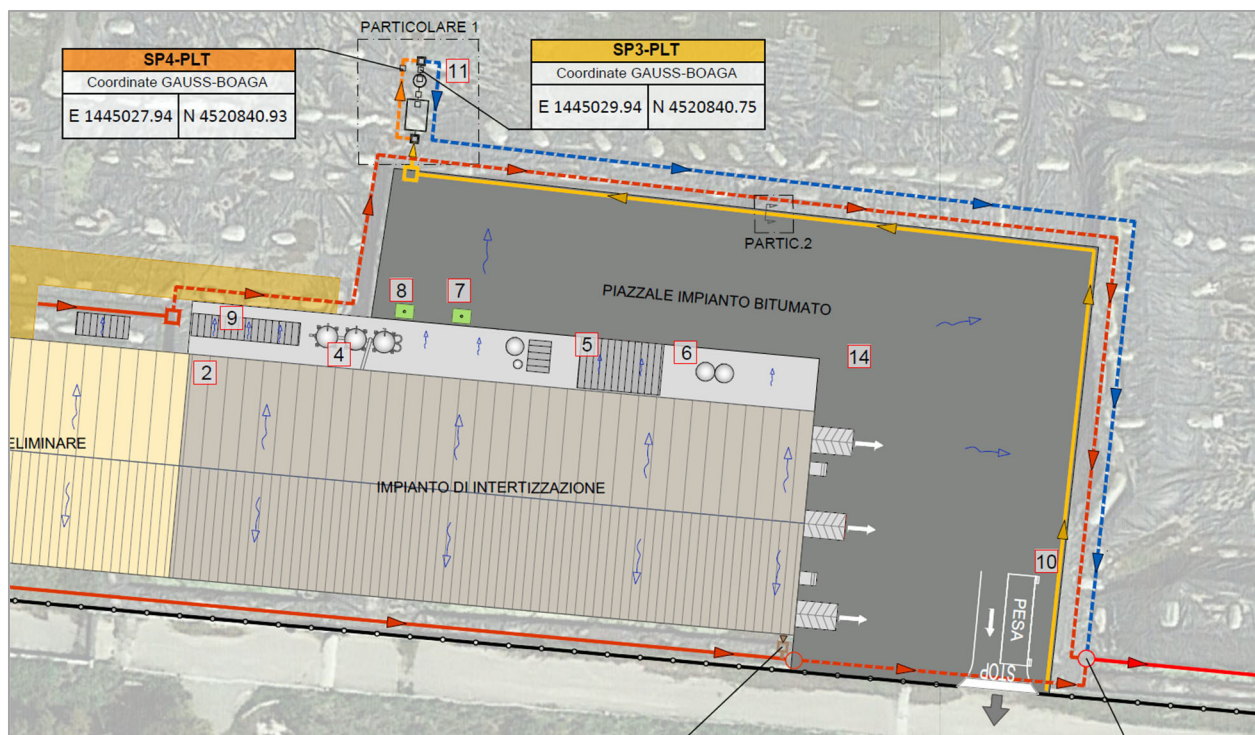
Planimetria di dettaglio del piazzale bitumato posto in prossimità al fabbricato dell'Impianto di Inertizzazione (in giallo la linea dedicata alle acque meteoriche ricadenti sul piazzale bitumato – in azzurro la linea di smaltimento acque di prima pioggia trattate e acque di seconda pioggia).
